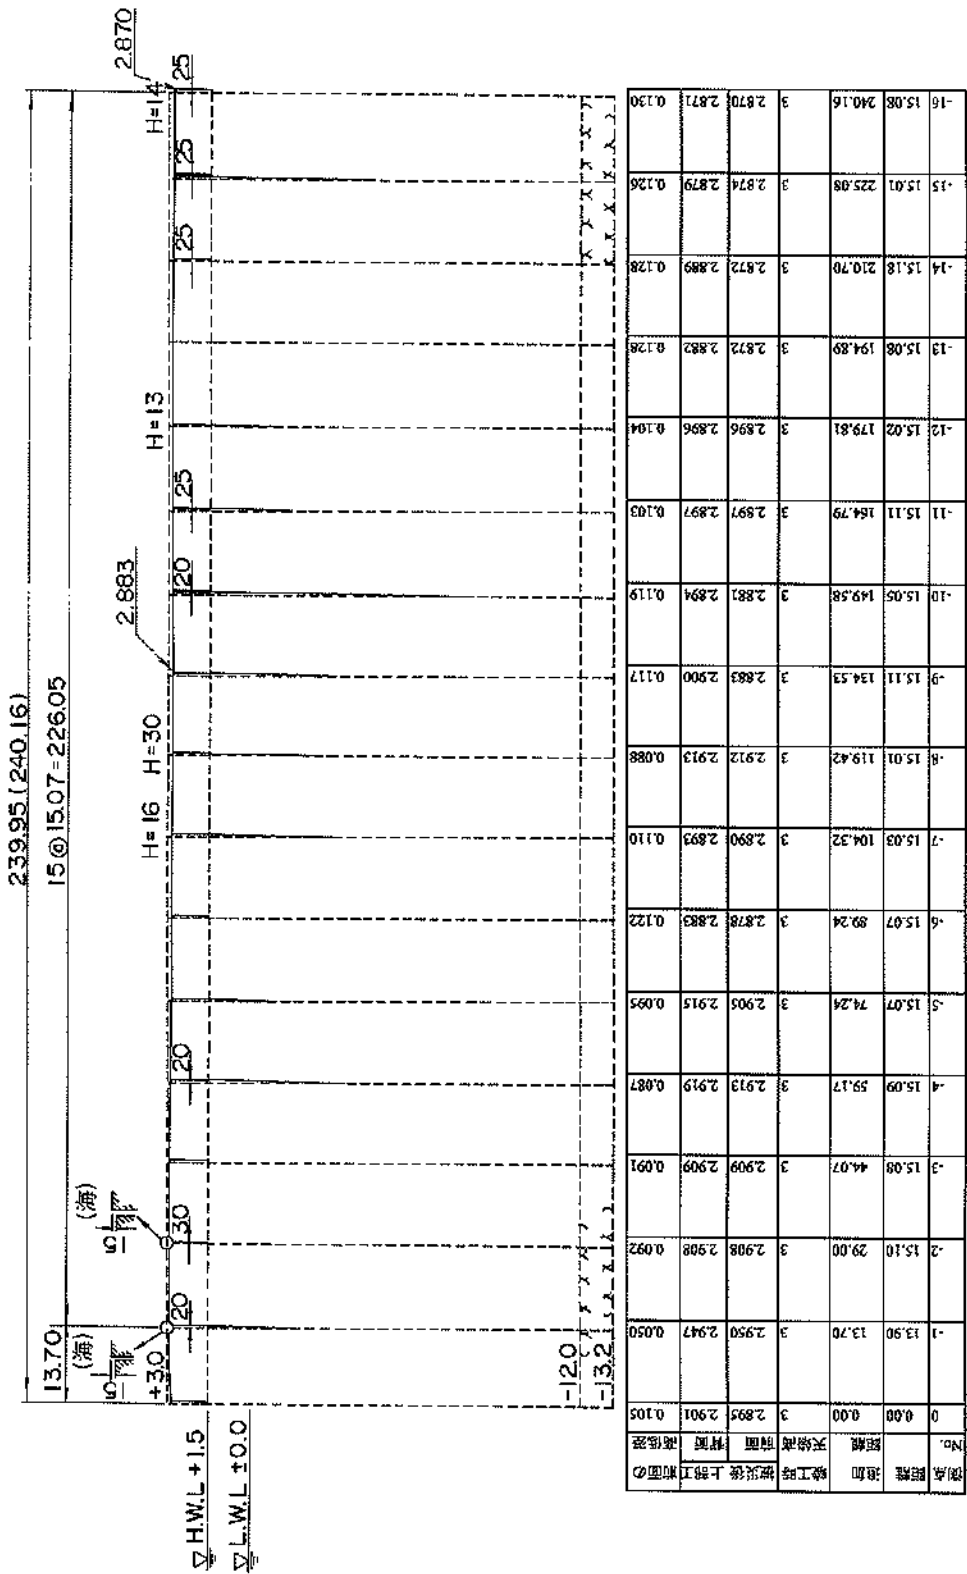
縦断面図 (第3埠頭地区, ⑤西側岸壁 (-12.0m))
